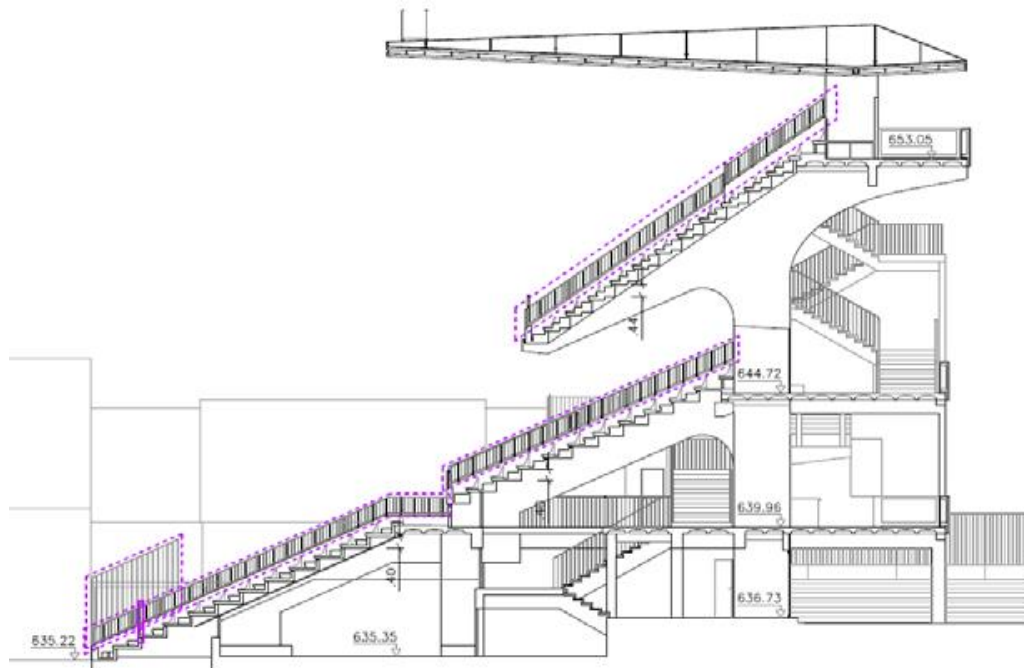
Sección tipo del Estadio de Vallecas (extractada del proyecto de reforma y adecuación a la ITE)
